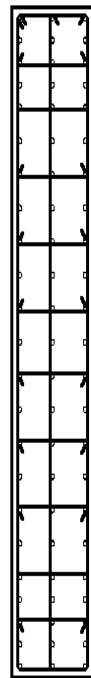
Armado de acero transversal de muro dirección X nivel 2 (ver planos de detalles).
